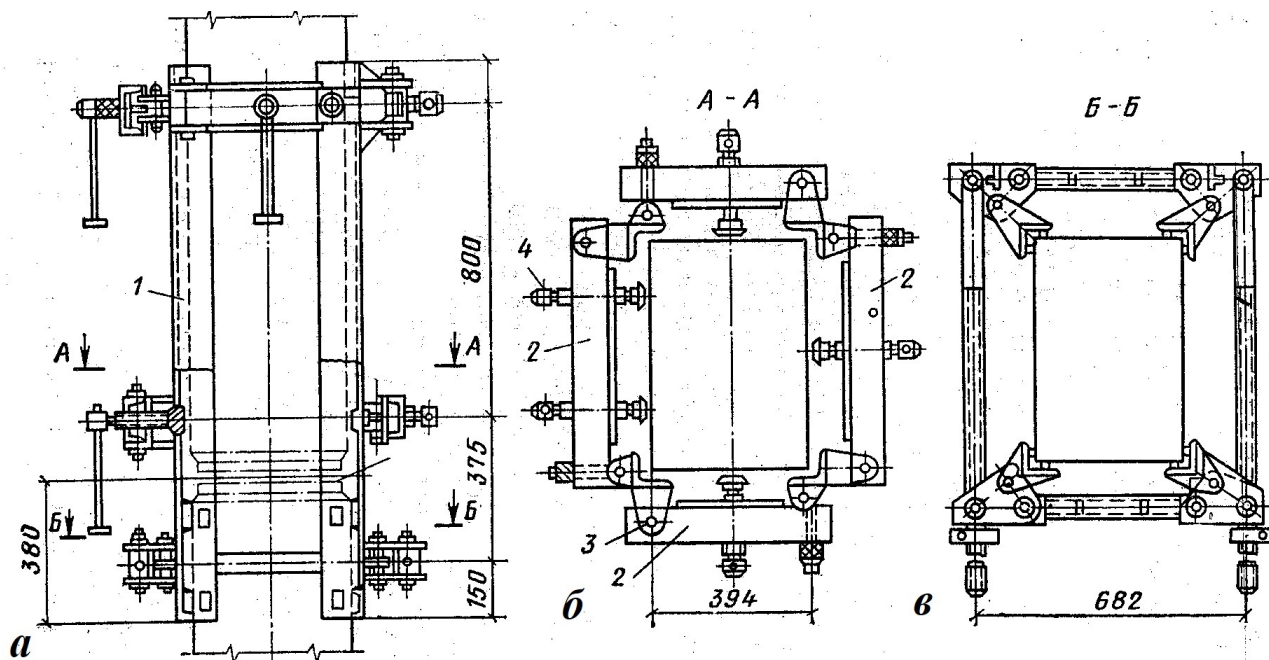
Рамний кондуктор для установки і вивірки колон багатопверхових промислових будинків: а – загальний вигляд; б – вид зверху регулювального пристрою; в – те ж затискного пристрою; 1 – рамний каркас; 2 – балочка; 3 – шарніри; 4 – регулювальні гвинти
